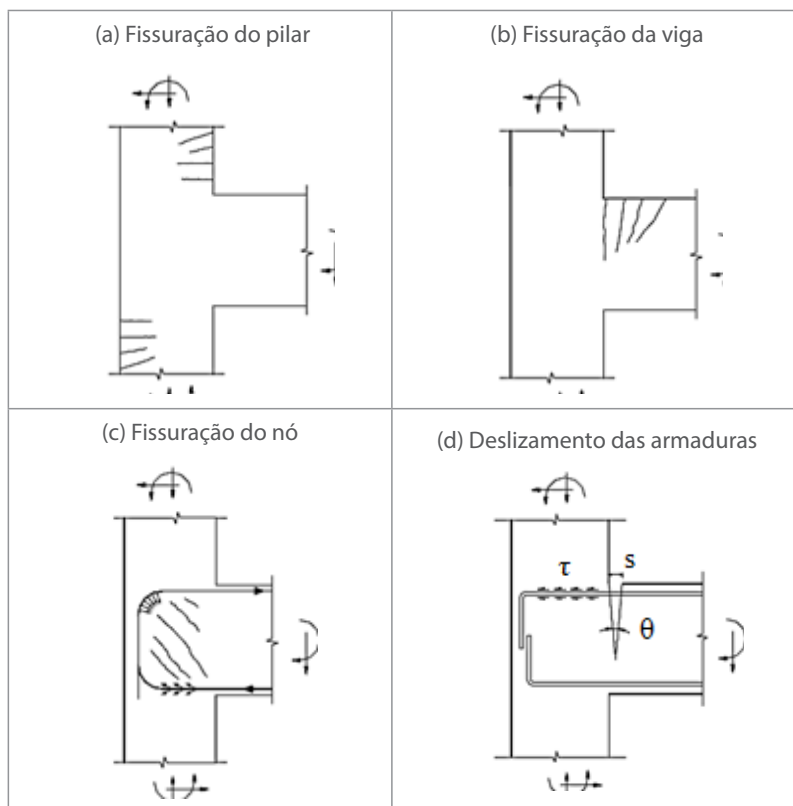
Fissuração e deslizamento das armaduras existentes em nós de pórtico
